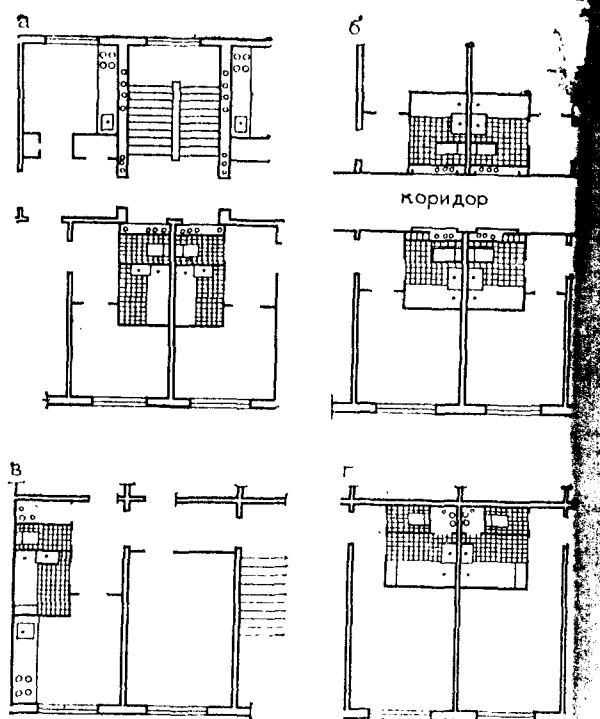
Примеры размещения санитарных помещений в планах объемно-блочных зданий
